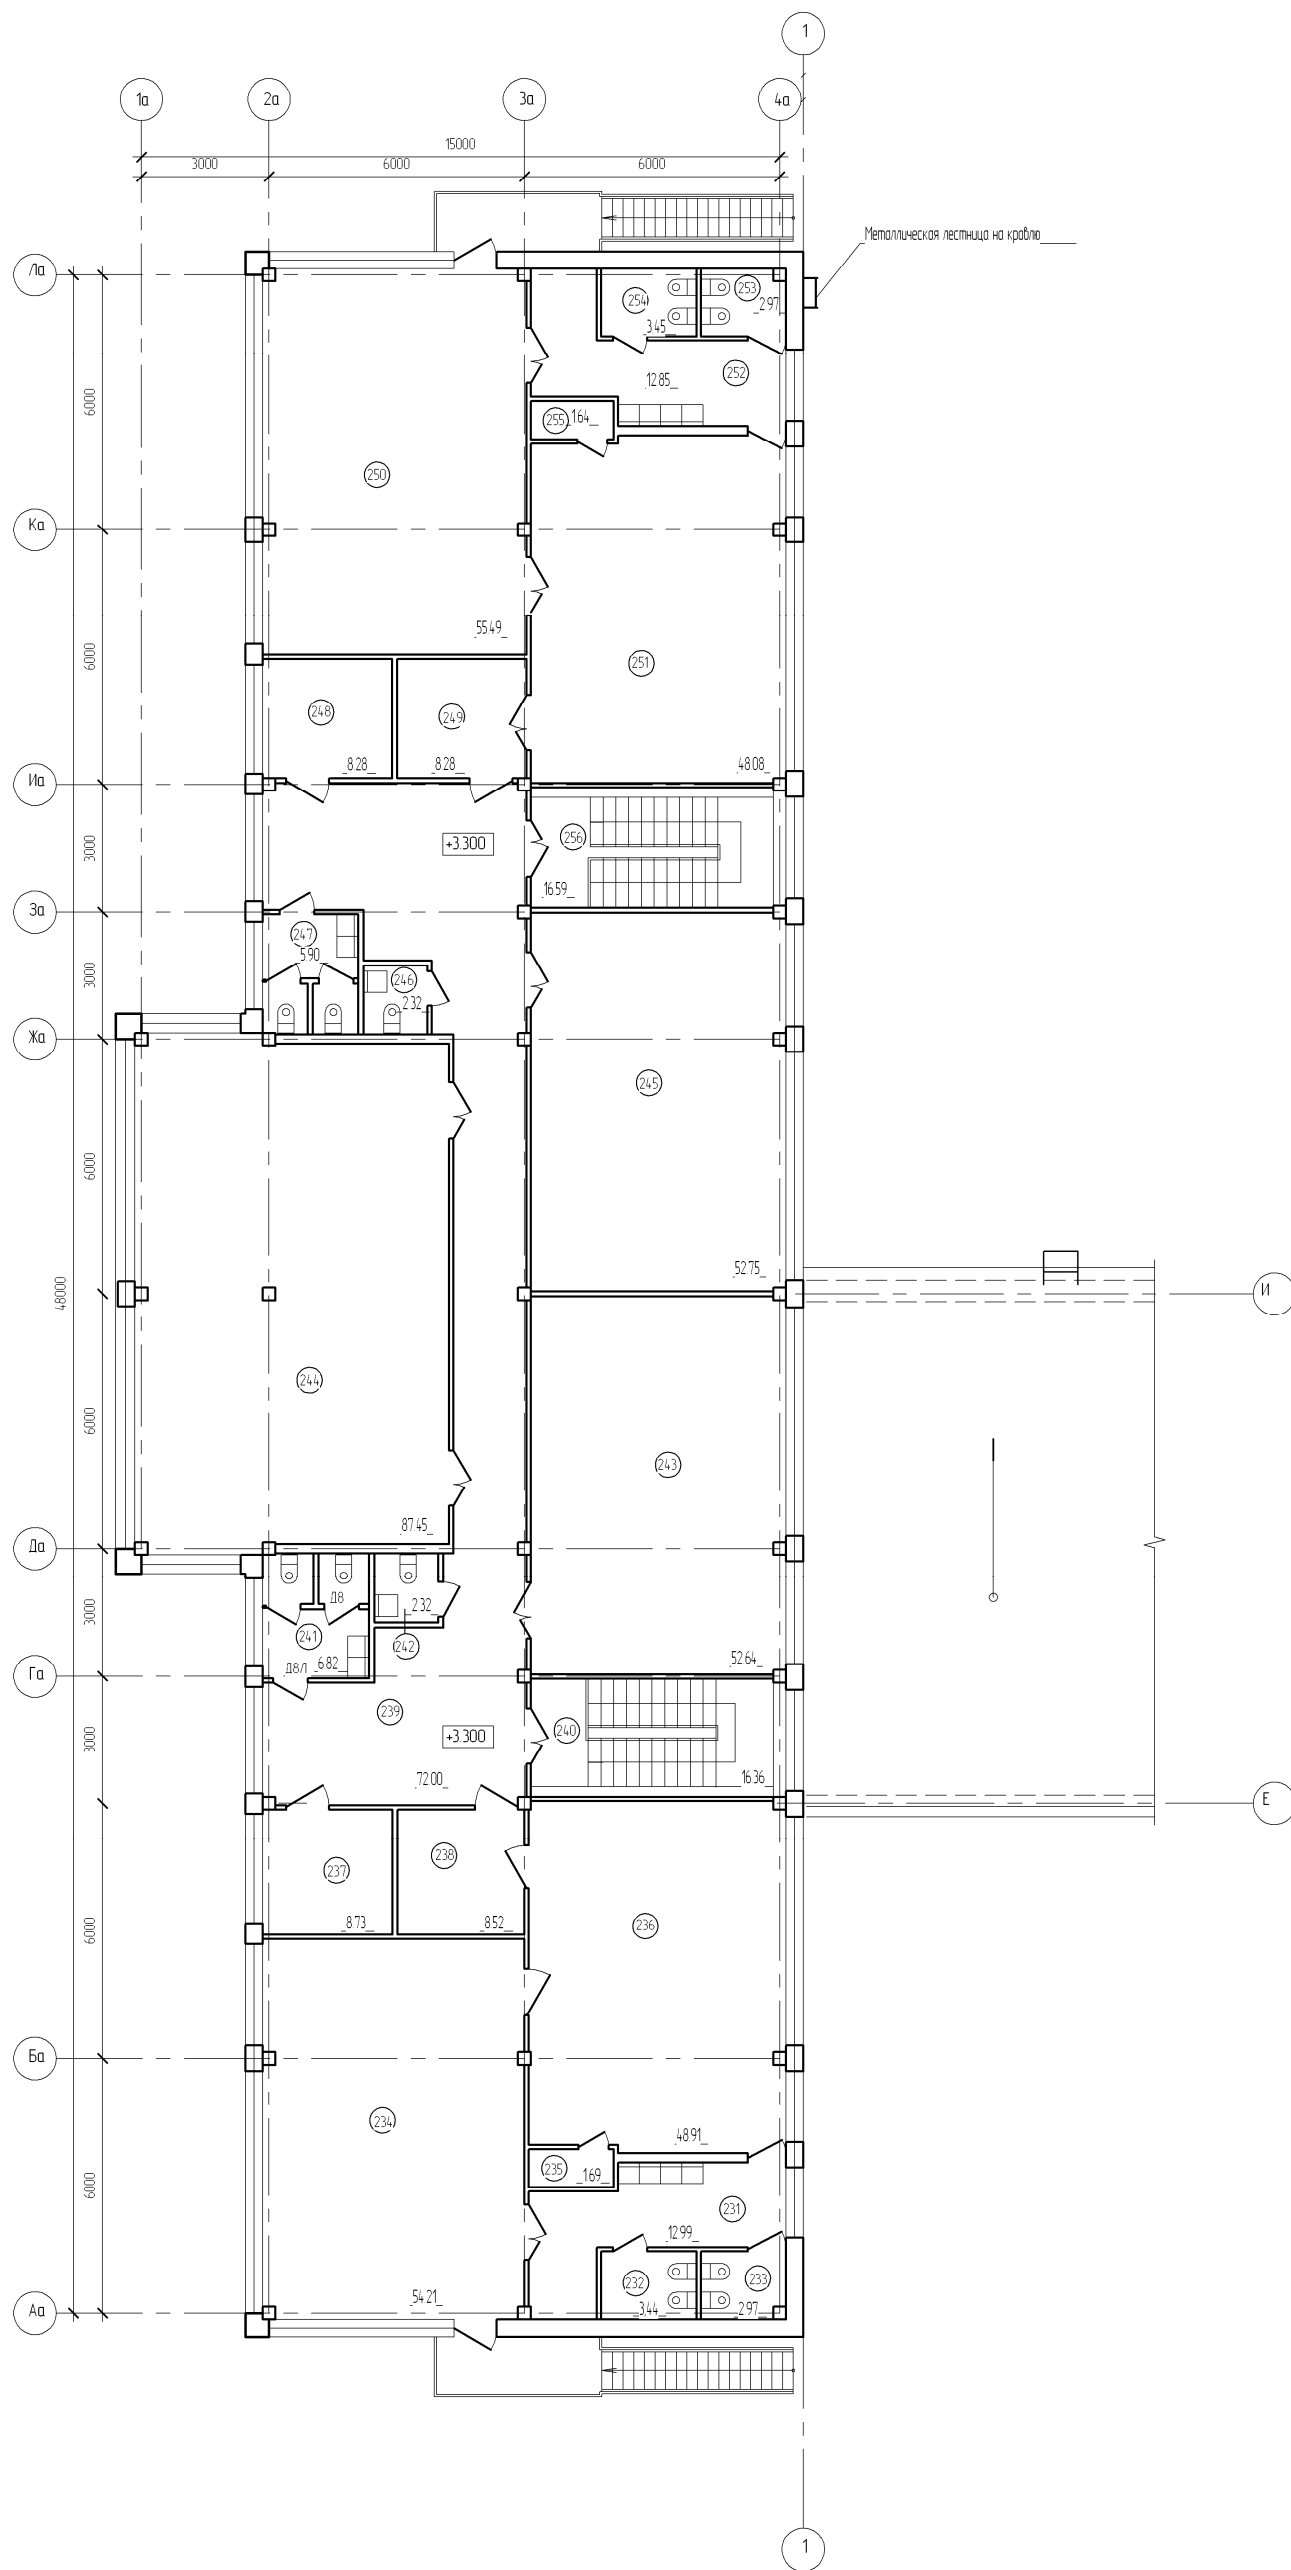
План 2-го этажа здания Детского сада на 60 мест с начальной школой на 100 учащихся
